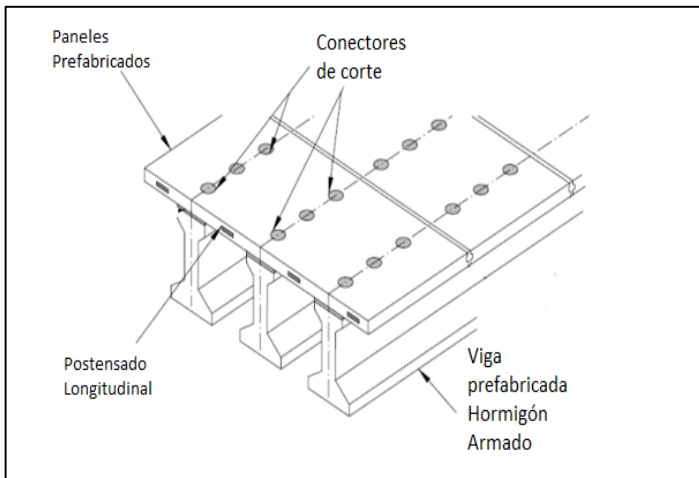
Conectores de Corte para Paneles Prefabricados. Fuente: *Recommendations for the Connection Between Full-Depth Precast Bridge Deck Panel Systems and Precast I-Beams* (2007).
